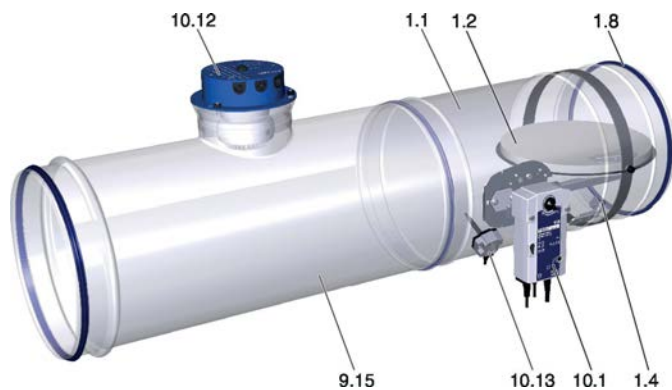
FKR-EU mit Federrücklaufantrieb und Rauchauslöseeinrichtung in einer runden Luftleitung
